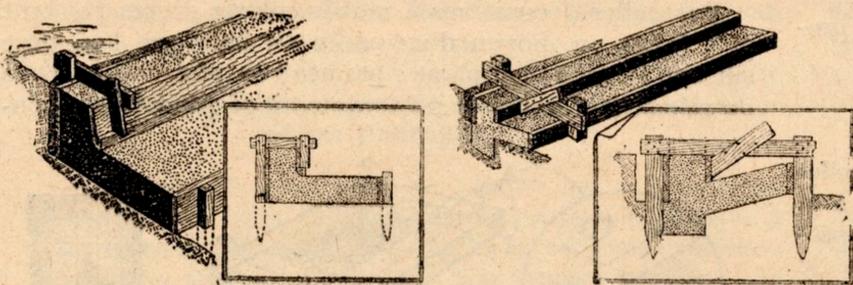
et 7. — Coffrage de bordures avec caniveaux.
